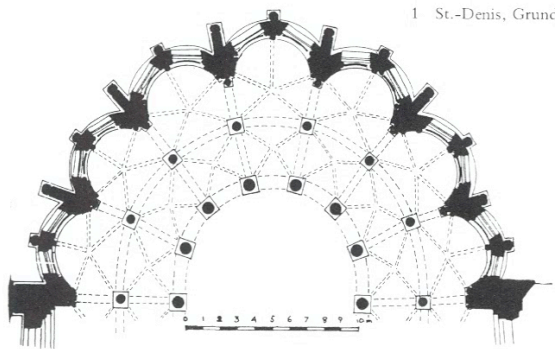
Grundriss des Chors von Saint-Denis
